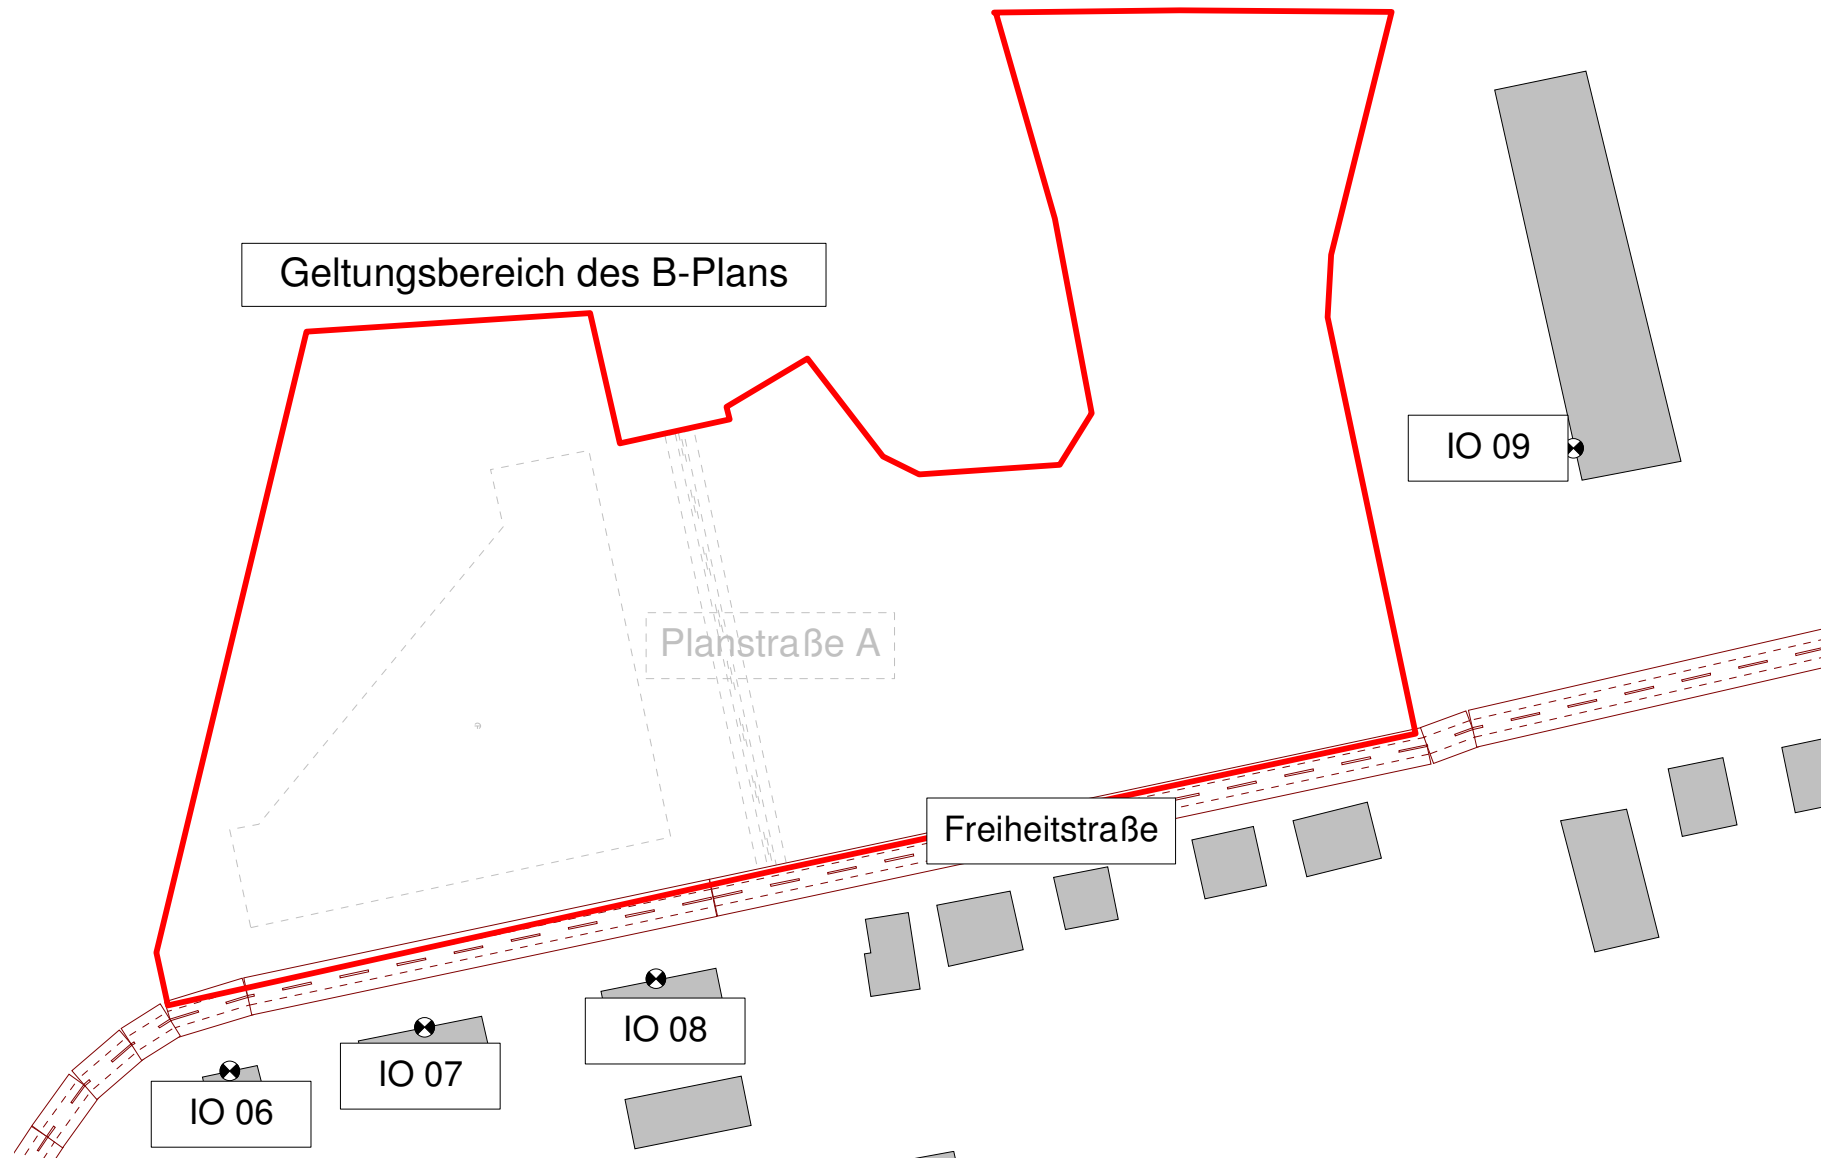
Lageplan „Prognose-Nullfall“ (ohne geplante Bebauung)
